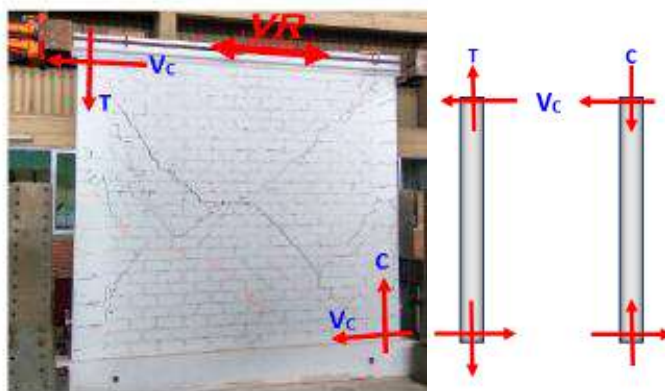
Equilibrio de fuerzas internas en muro agrietado.
